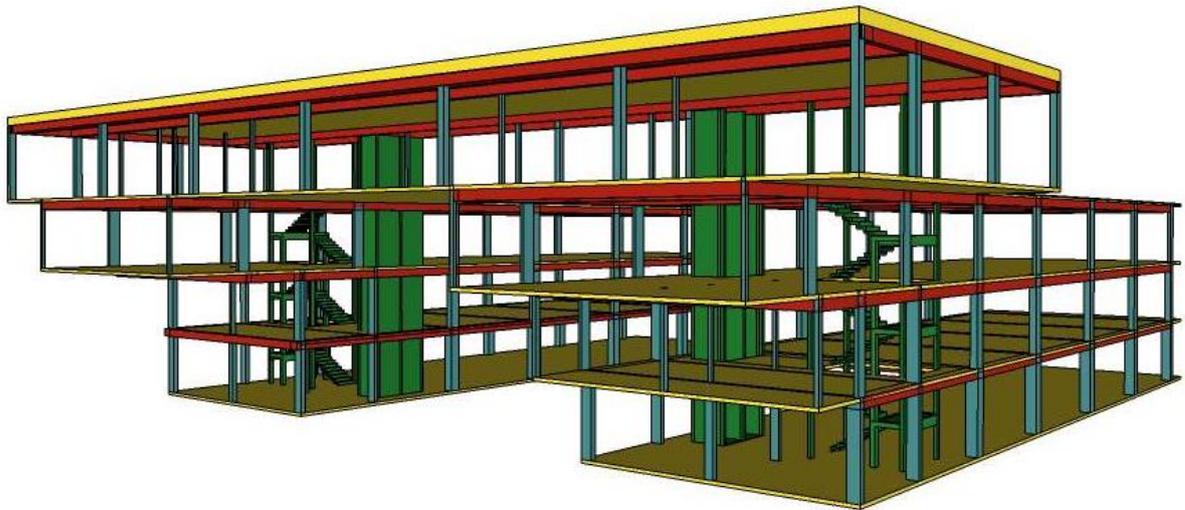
Elementos Estruturais pavimento do subsolo, inferior, térreo e superior.
